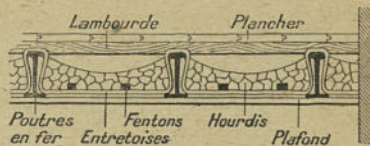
Poutrage en fer, avec hourdis de plâtre et plancher.
